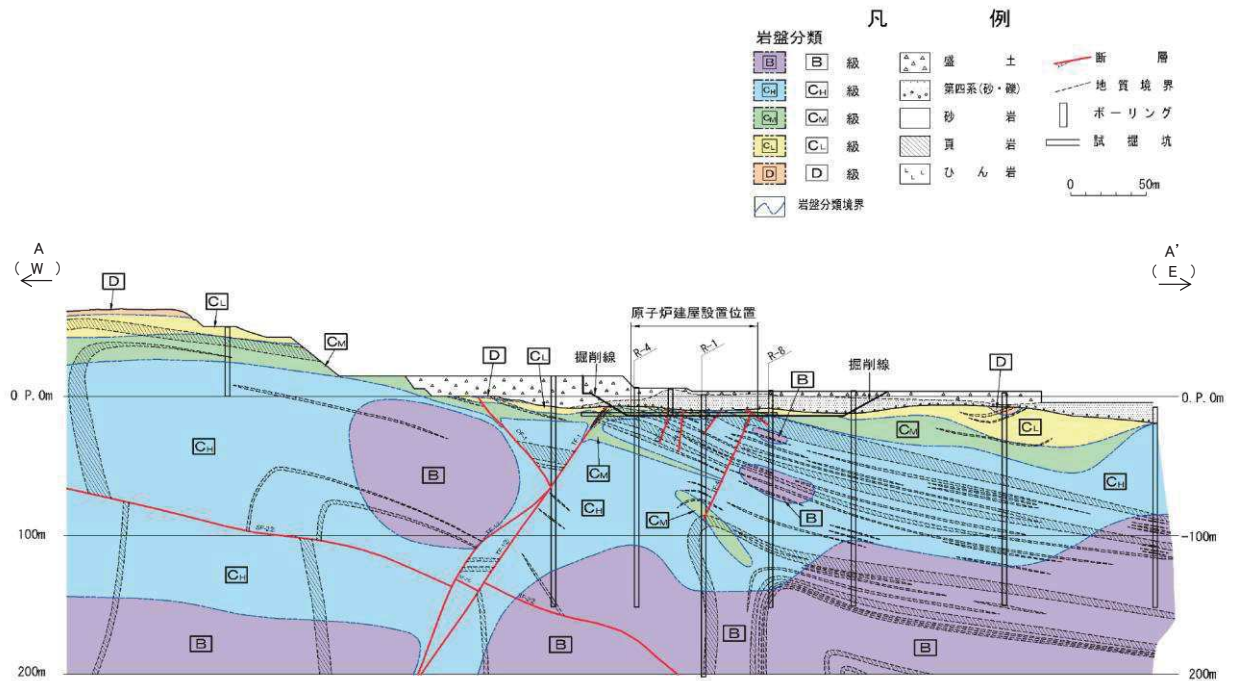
地質断面図 (第 2 号機原子炉建屋中央, 東西方向) (A-A' 断面)
